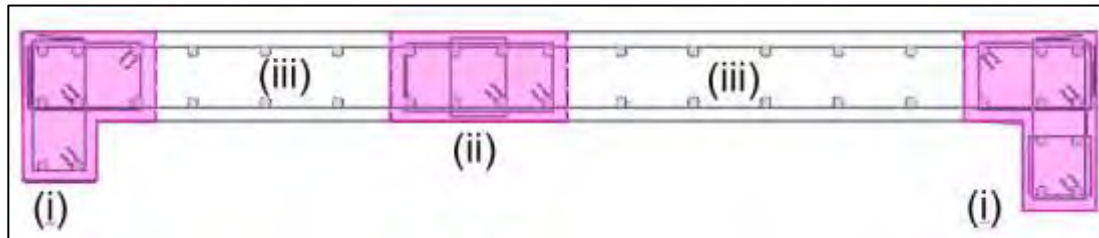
Tipo de Refuerzo Vertical en Placas
